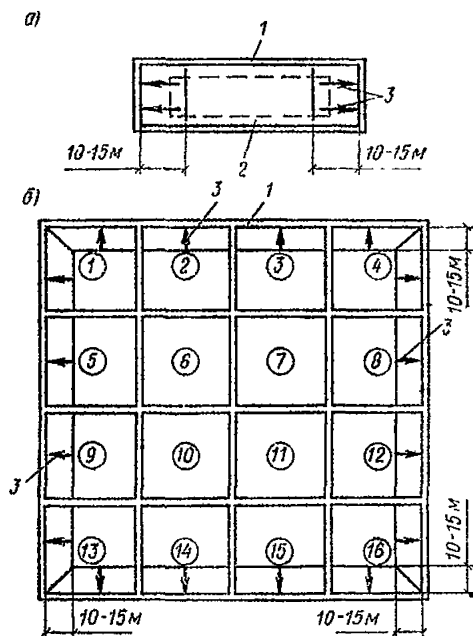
Схема планировки котлованов и карт для замачивания *а* — под небольшое здание; *б* — при замачивании на всей застраиваемой площади; 1 — обвалование и контур проектируемого здания; 2 — направление уклонов в котлованах и картах, 1—16 (в кружках) — номера карт
